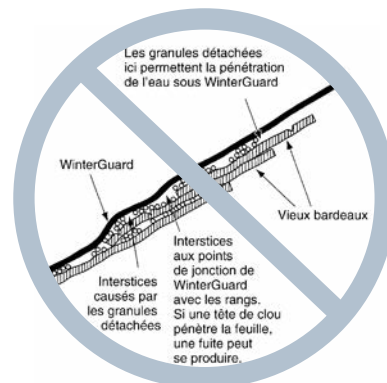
Problèmes d'installation de WinterGuard sur un vieux toit.
